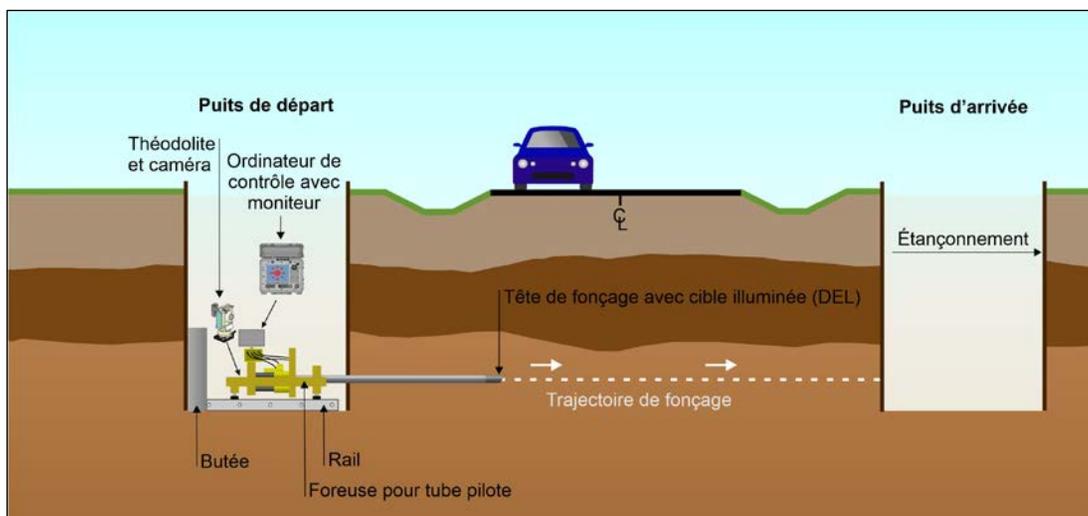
Tube pilote – Étape 1 – Fonçage et installation des tubes pilotes
